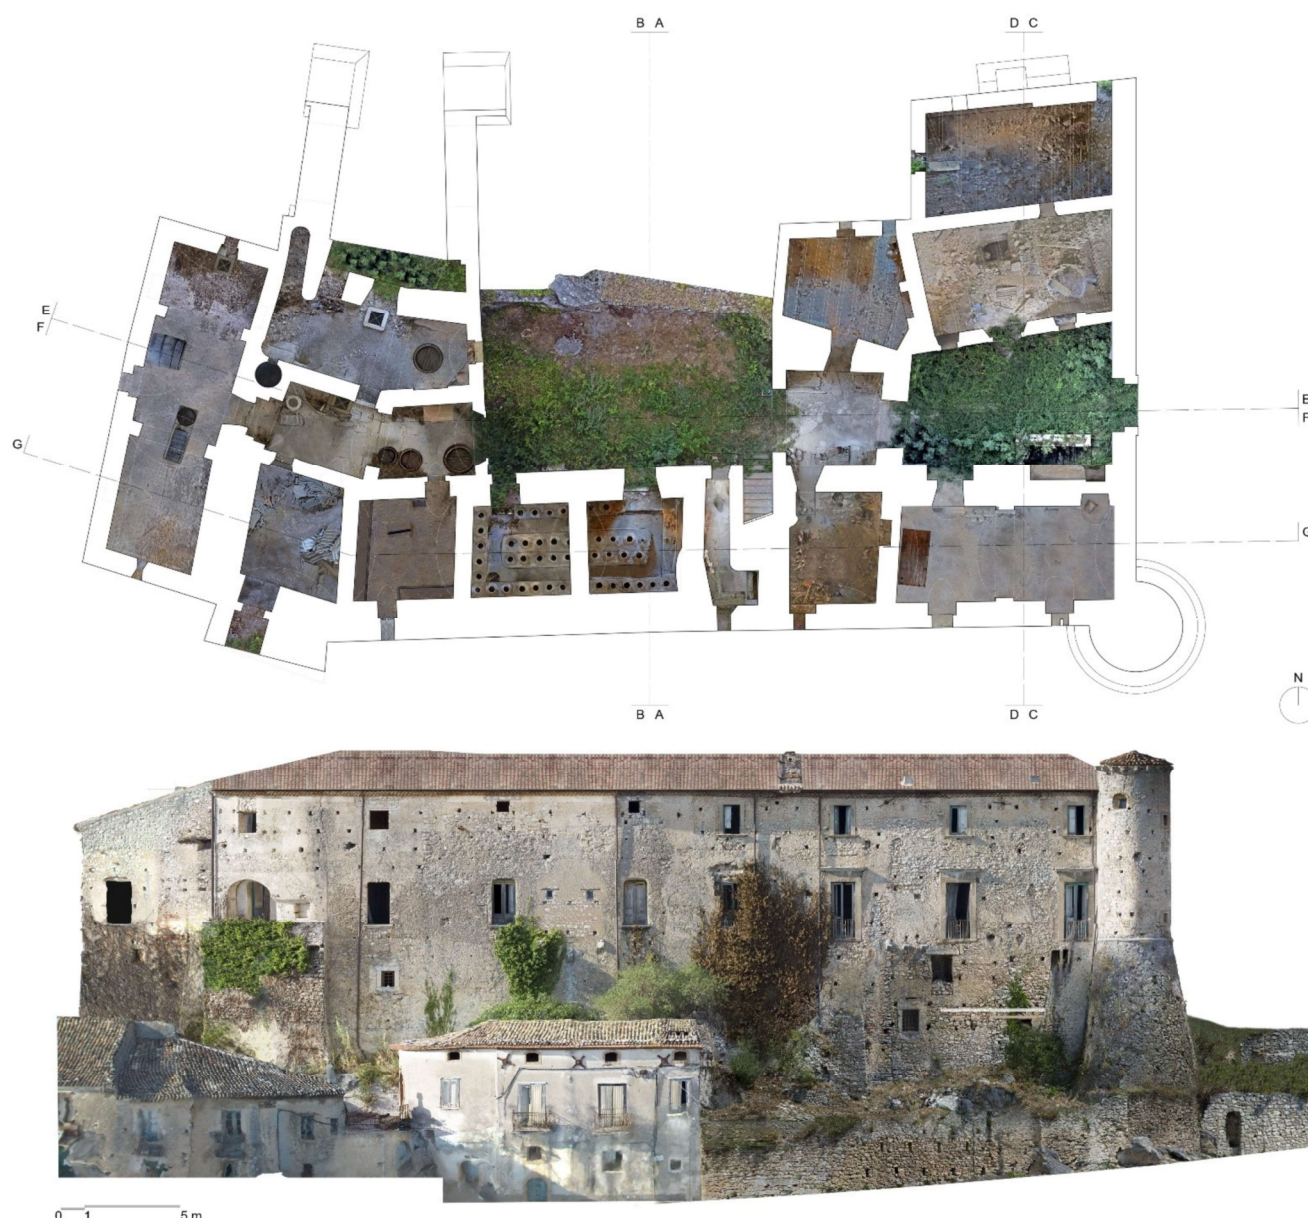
Castello di Sant'Angelo a Fasanella, pianta del piano terra e ortofoto del prospetto sud.
